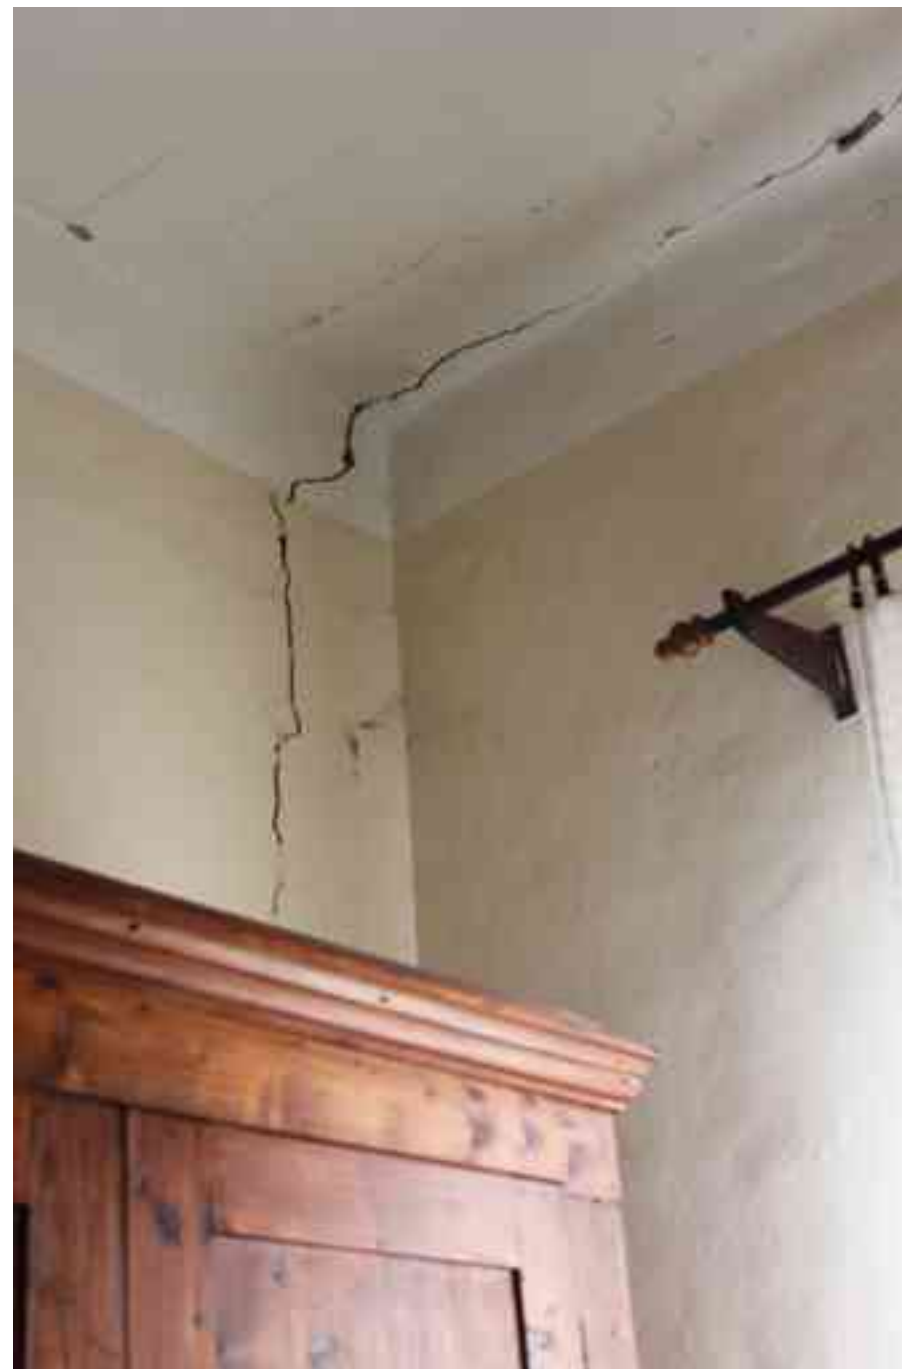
Fessura nella cappella laterale, prospetto sud.
